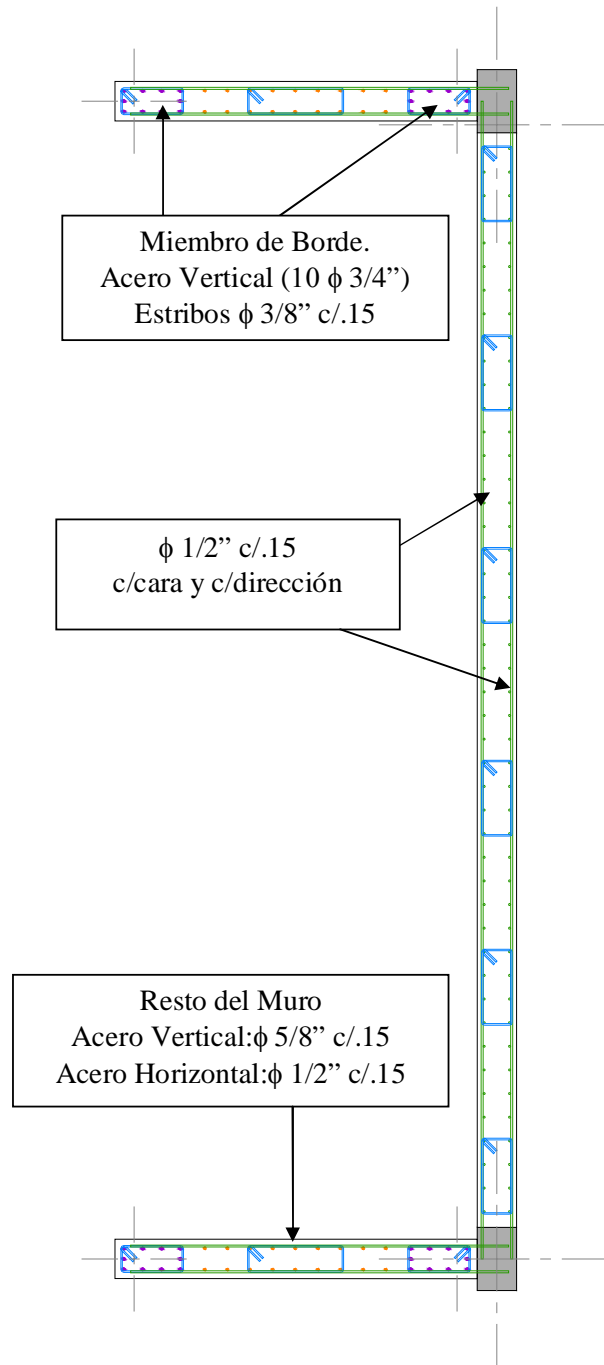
Detalle del Refuerzo Tipo 1 y Tipo 2 muy similar.
